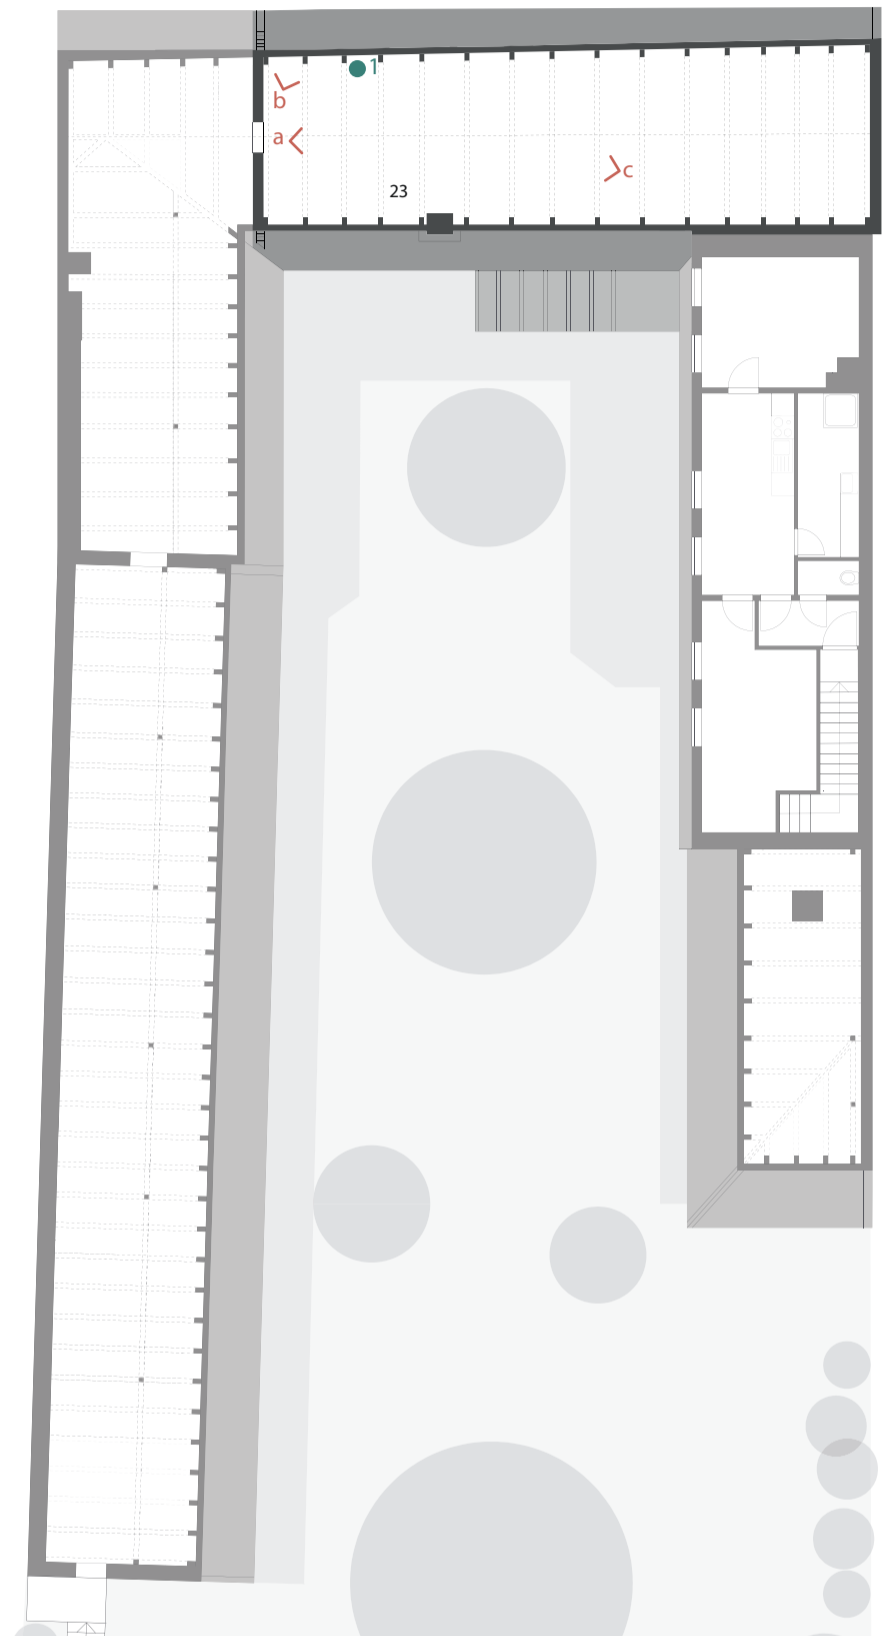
Grundriss Dachgeschoß | M 1:200 | Raum 23
